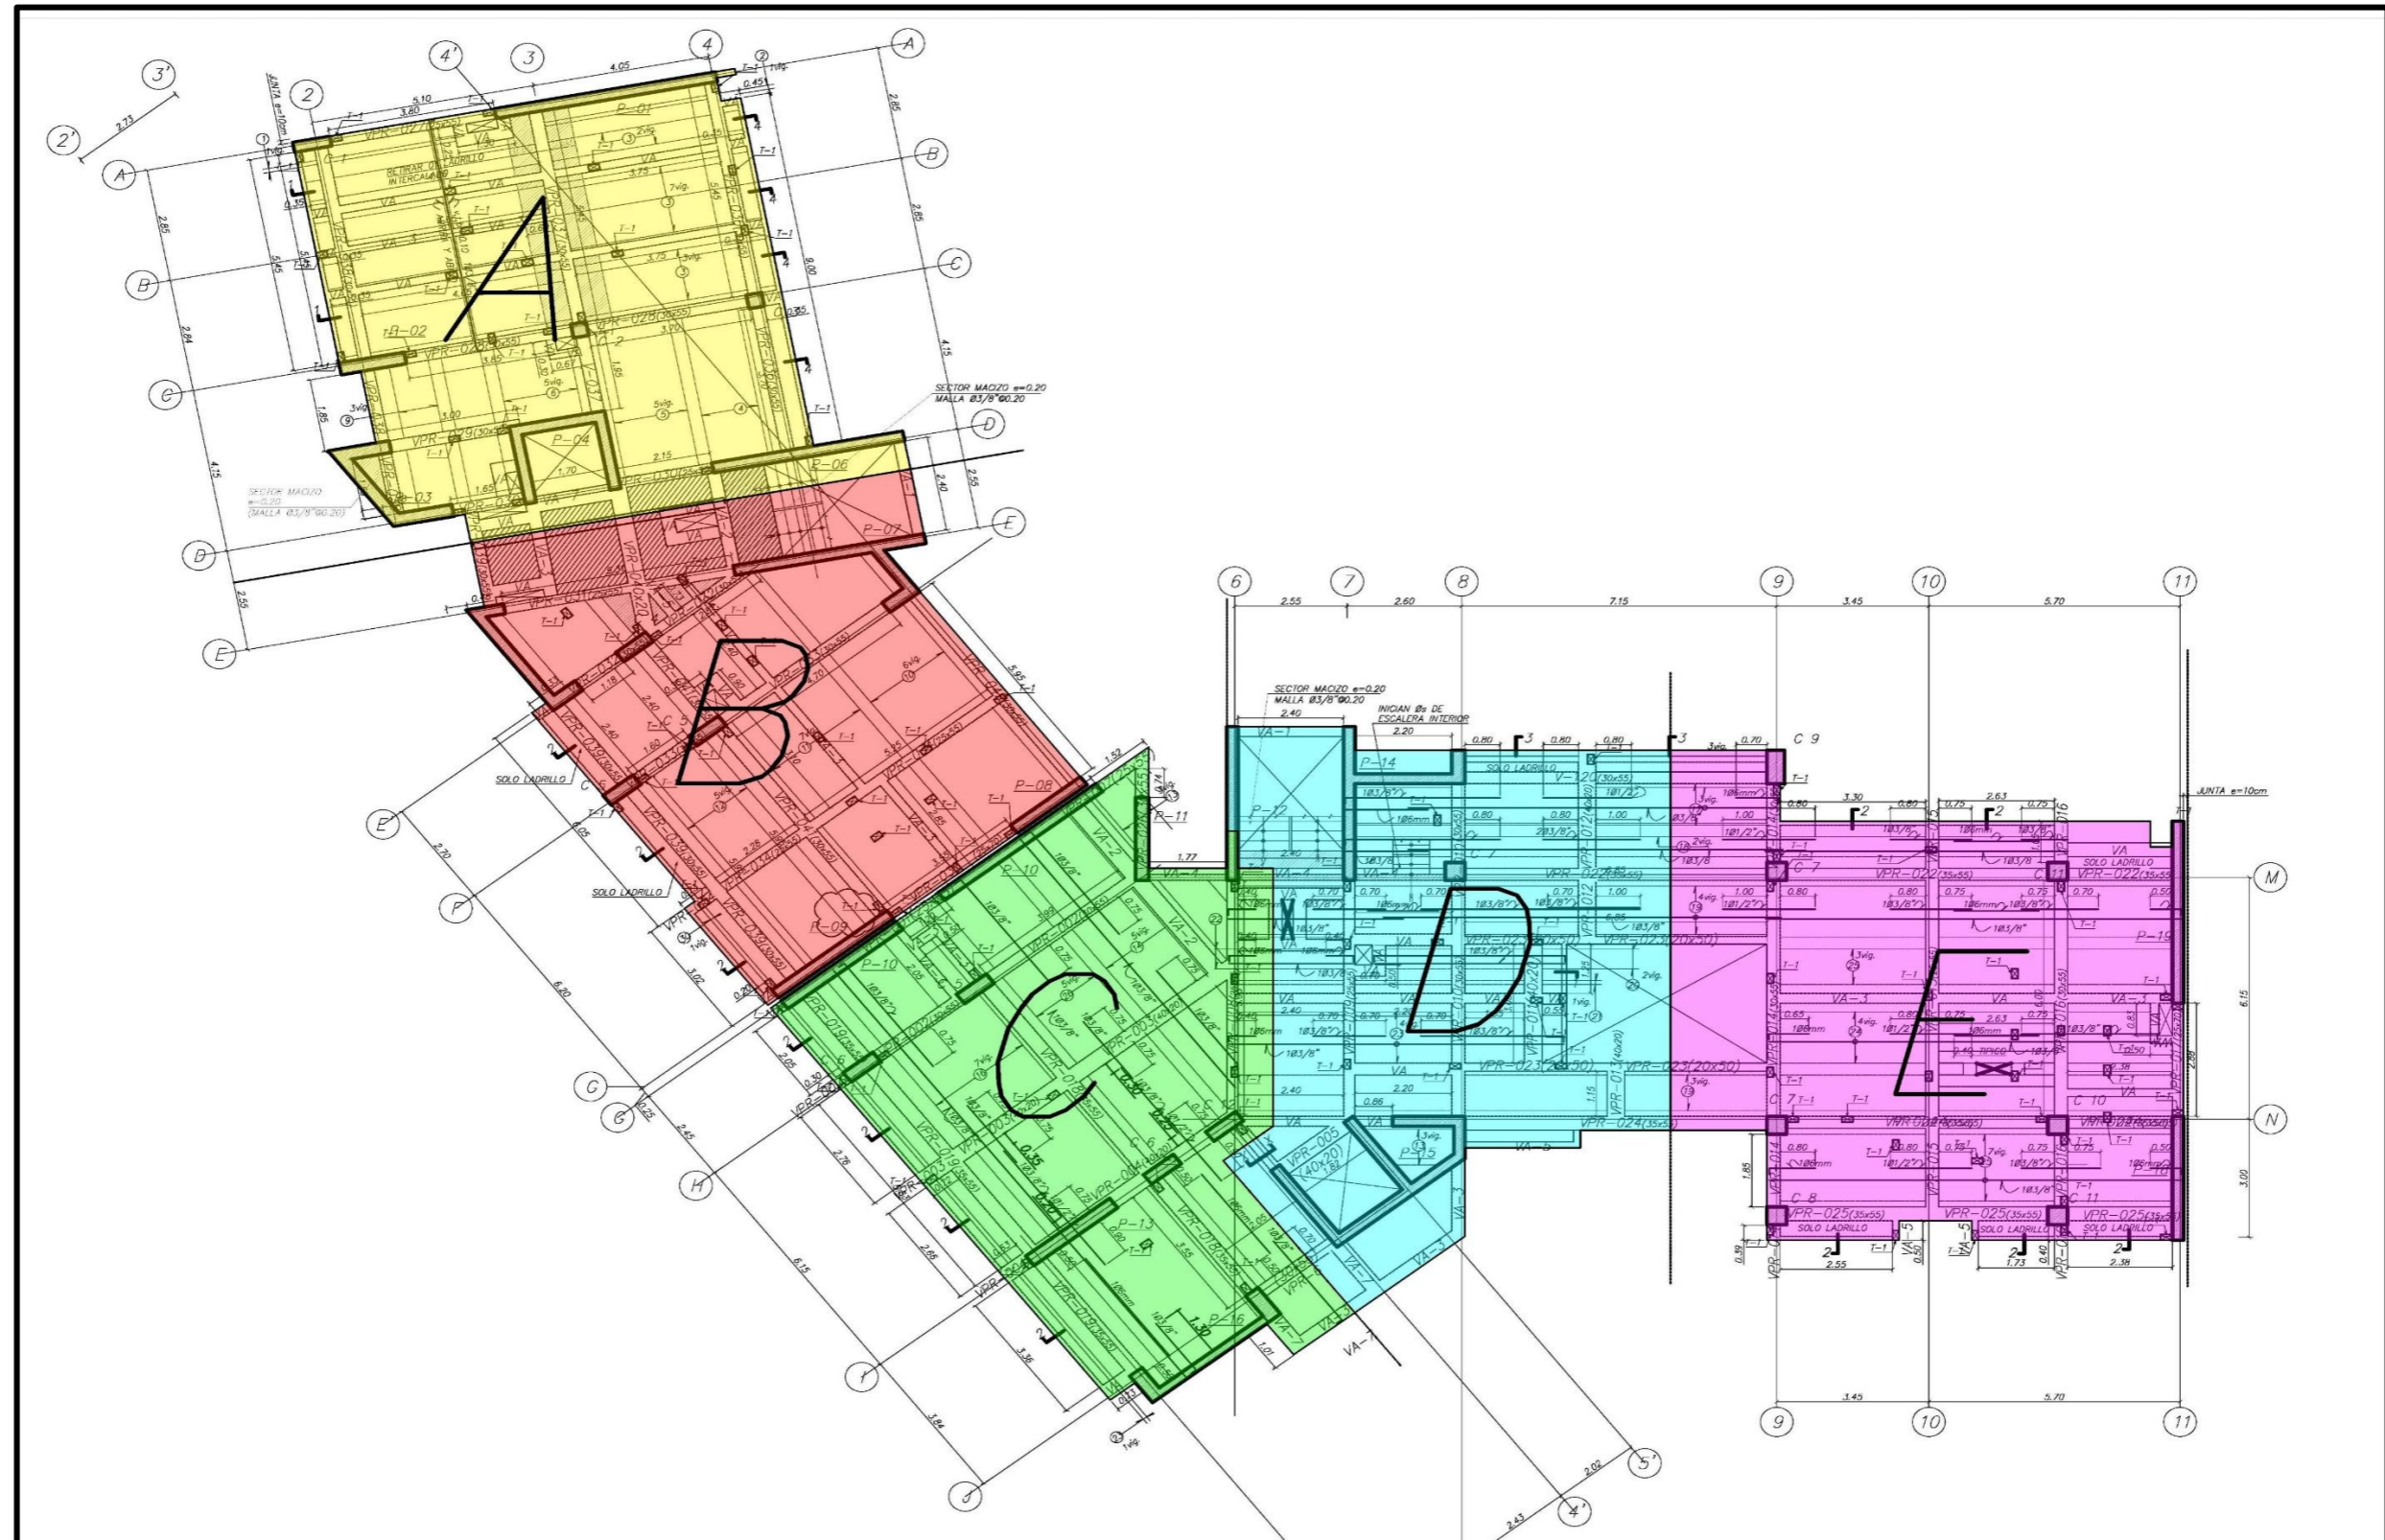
Sectorización general 5 sectores (Elementos horizontales)
